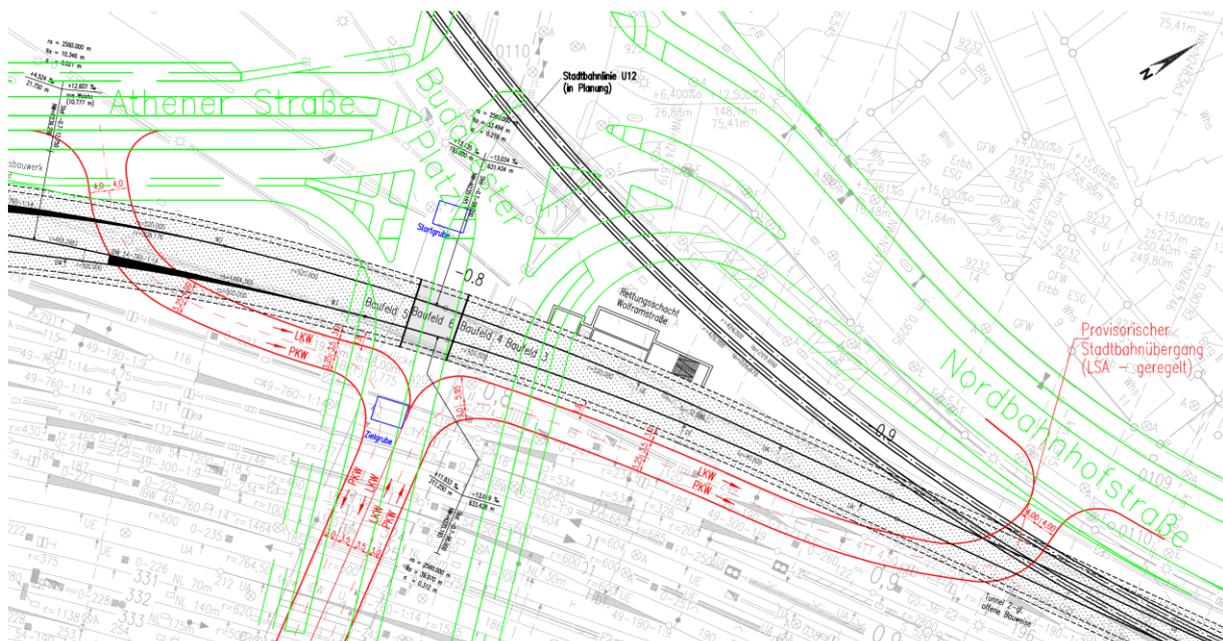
Ausschnitt Lageplan aus der Planfeststellung
